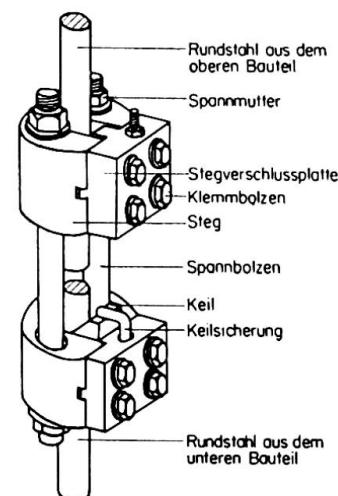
Montagehalterung nach O. PLATZER (Berlin) (Pat. ang.) [8].
